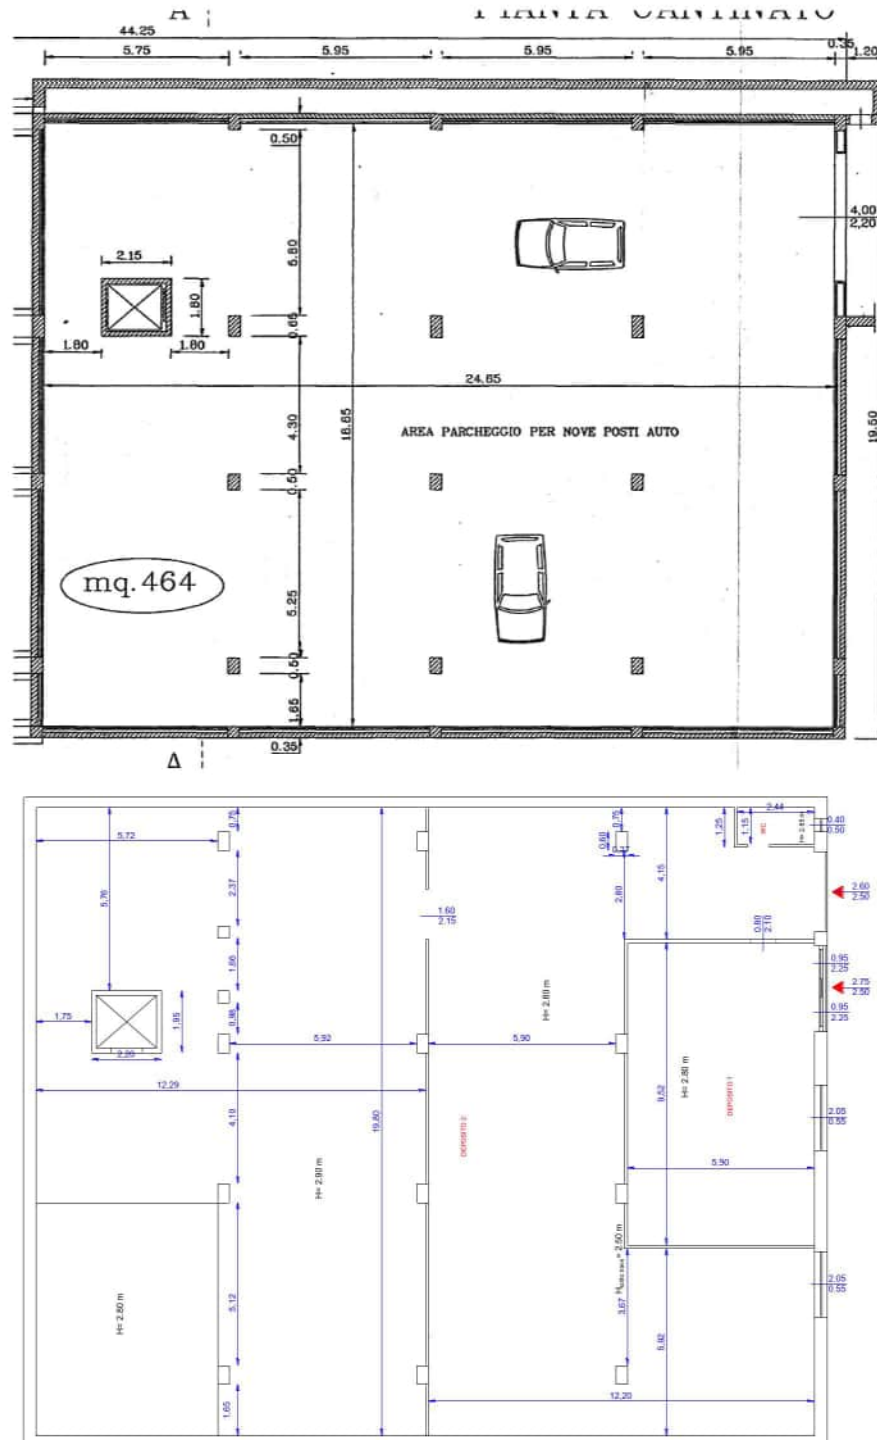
Raffronto planimetria progettuale (sopra) con planimetria da rilievo (sotto)
